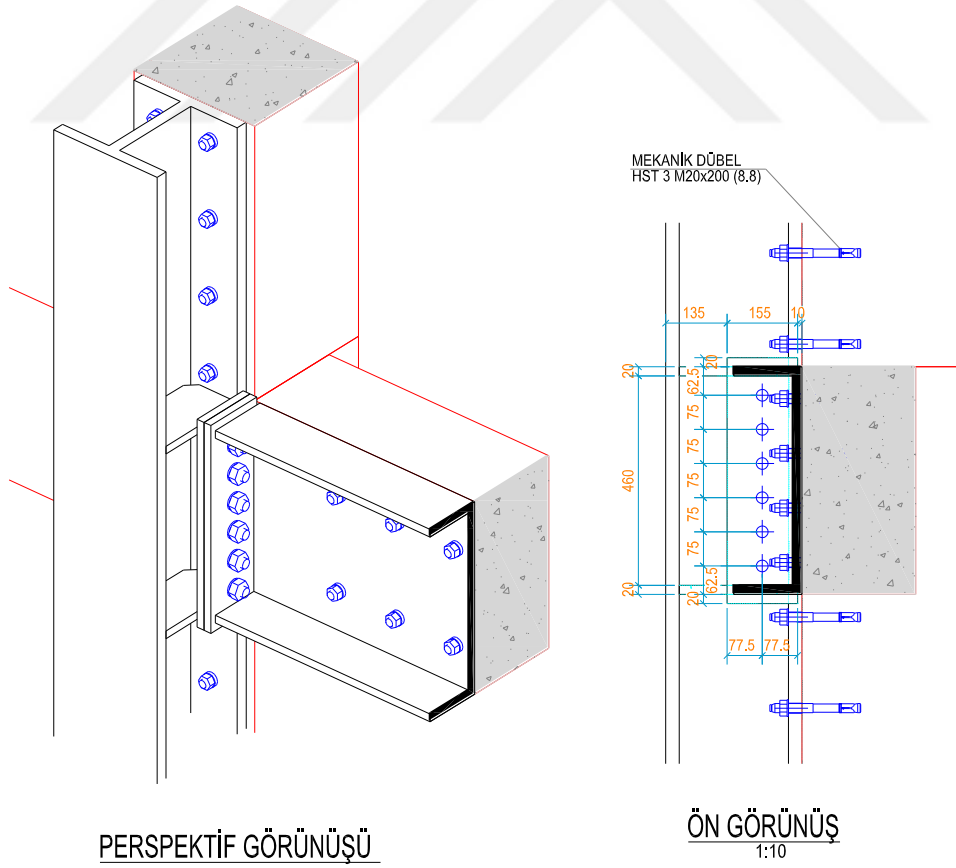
Şekil 3.21 arasında, SSB2B-2L modeline ait önerilen güçlendirme modeli için çelik sisteme ait 3B görünüş, plan, kesit, çelik çerçeve sisteminin bağlantı ve betonarme binaya sabitleme detayları verilmiştir. Burada verilen detaylar ve çelik eleman boyutları bina taşıyıcı sistem özelliklerine ve analiz parametrelerine göre değişebilir.
